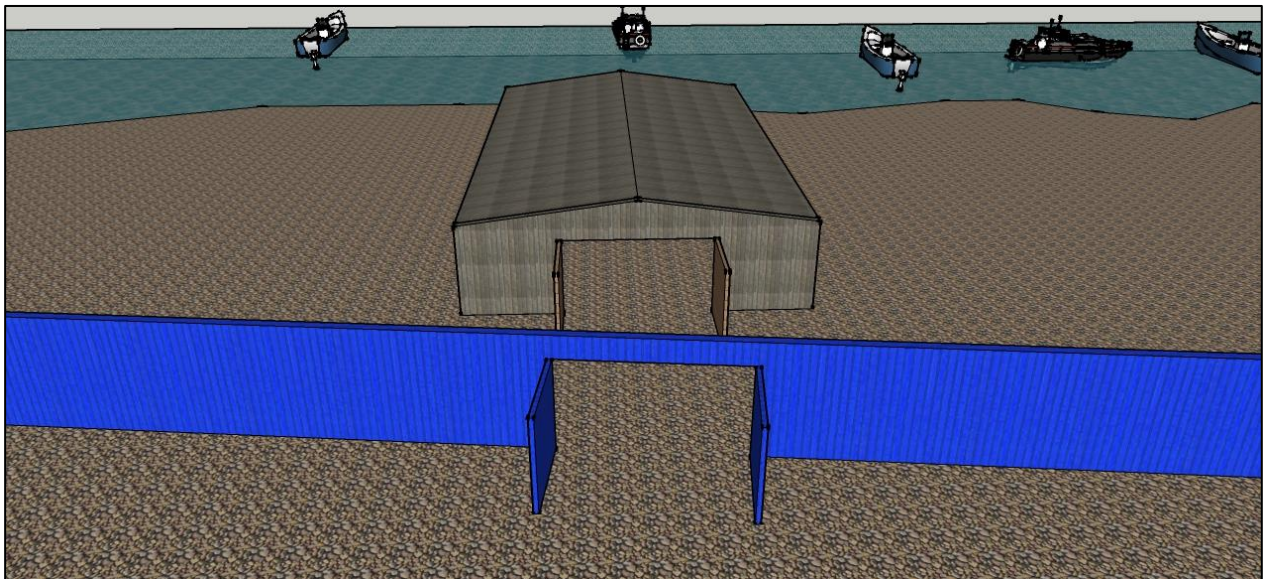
Esquema de galpón existente acondicionado acústicamente vista 2
